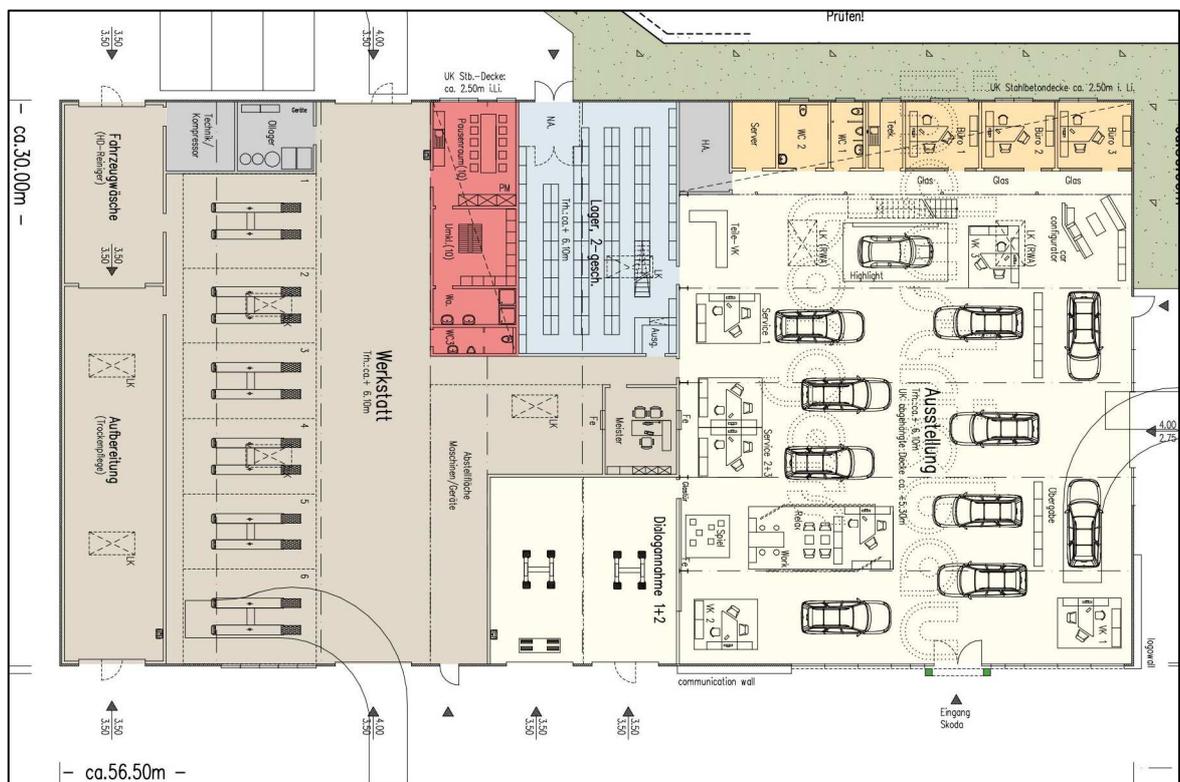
Grundriss der geplanten Räume (Stand 06/2015)
